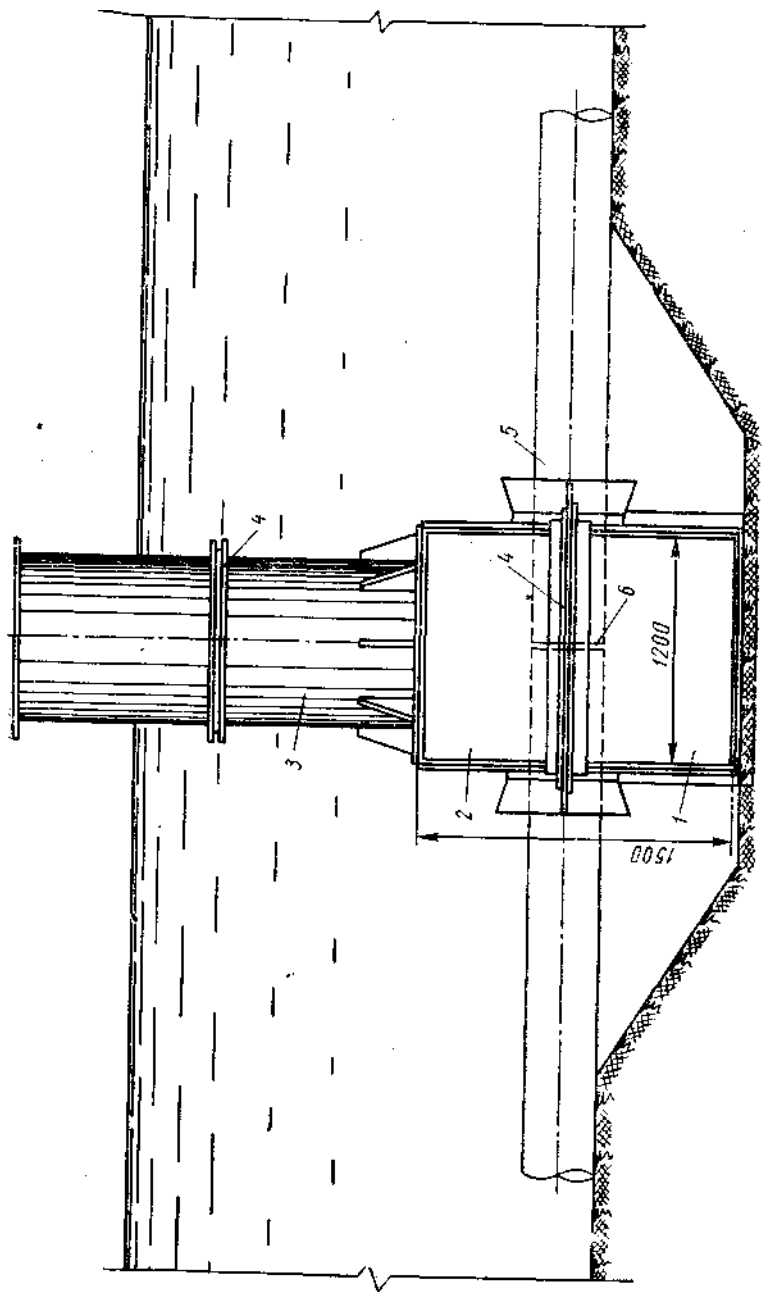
Металлический колодец для сварки труб под водой.
